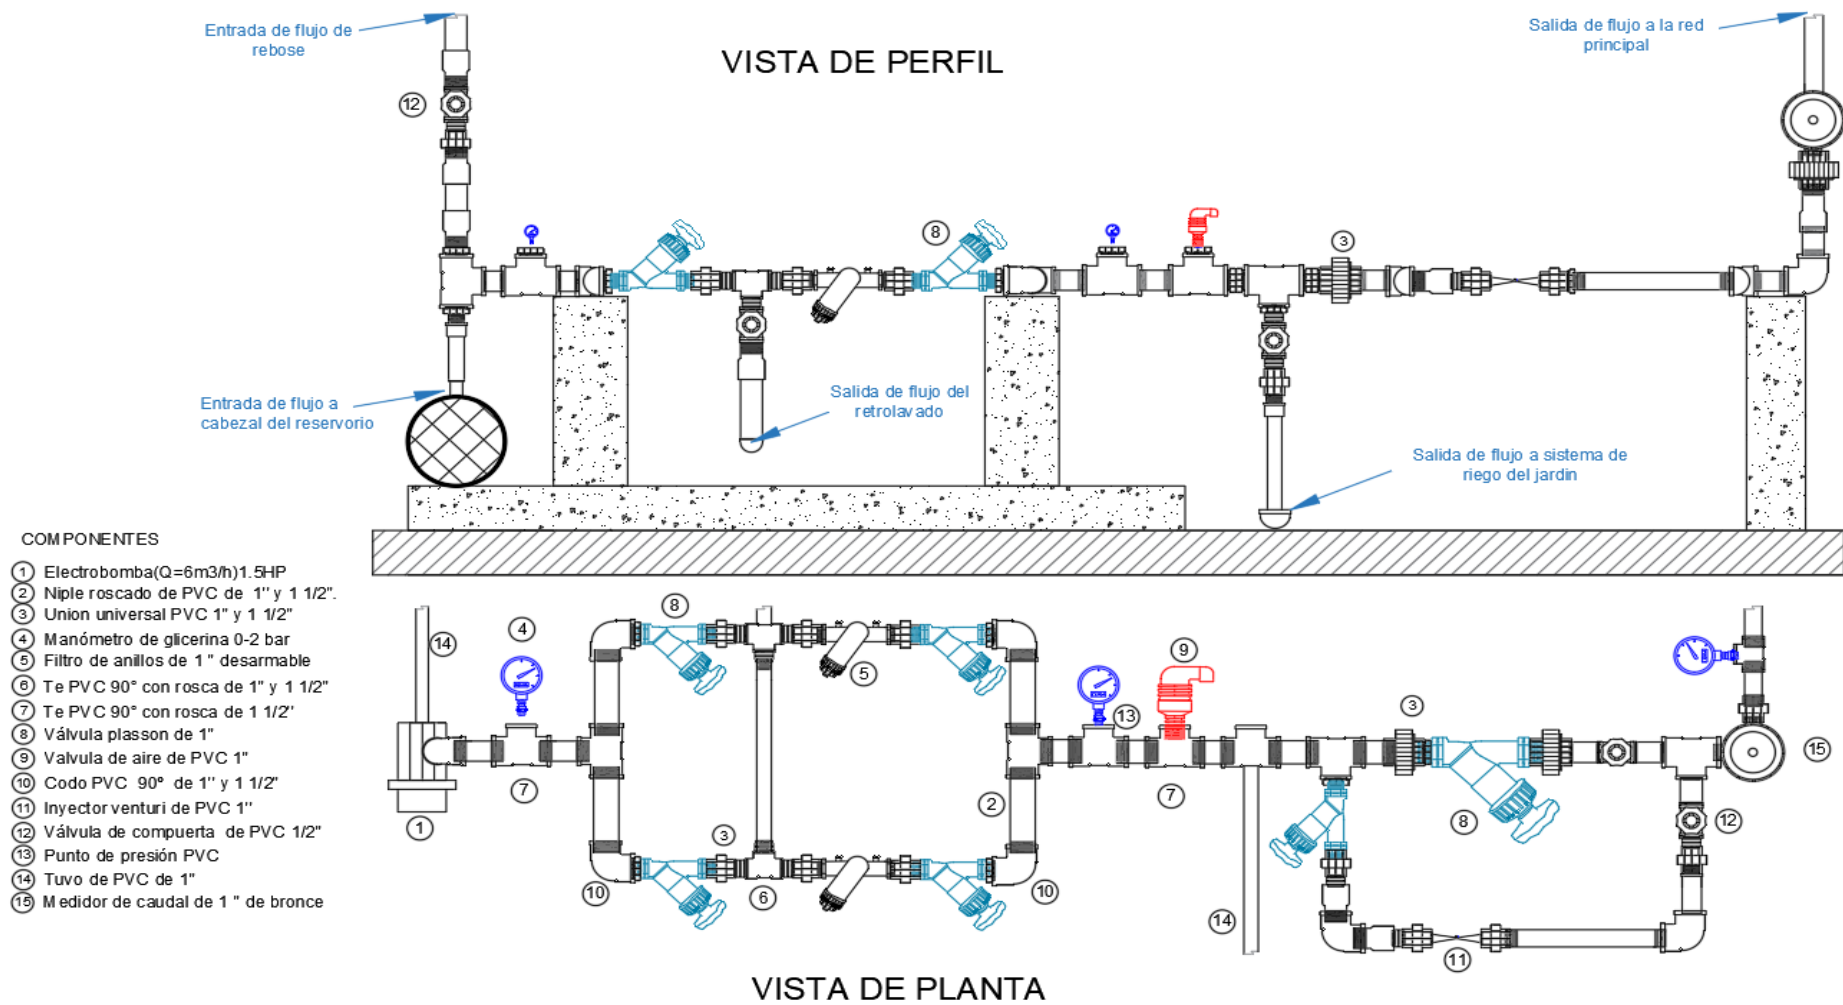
Detalles del cabezal de riego (Vista de perfil y planta) del Área experimental de Riego (AER)
